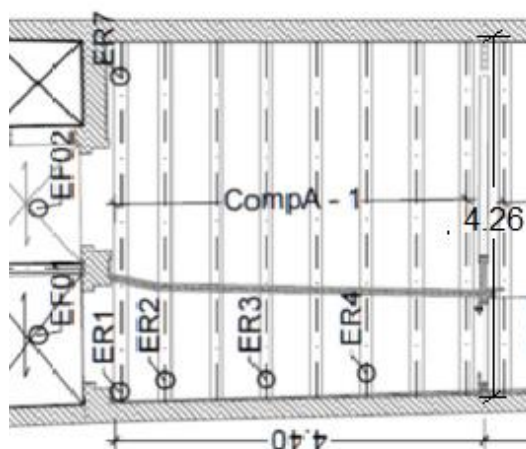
Planta estrutural do pavimento em estudo com os ensaios realizados pelo NCREP [16]
